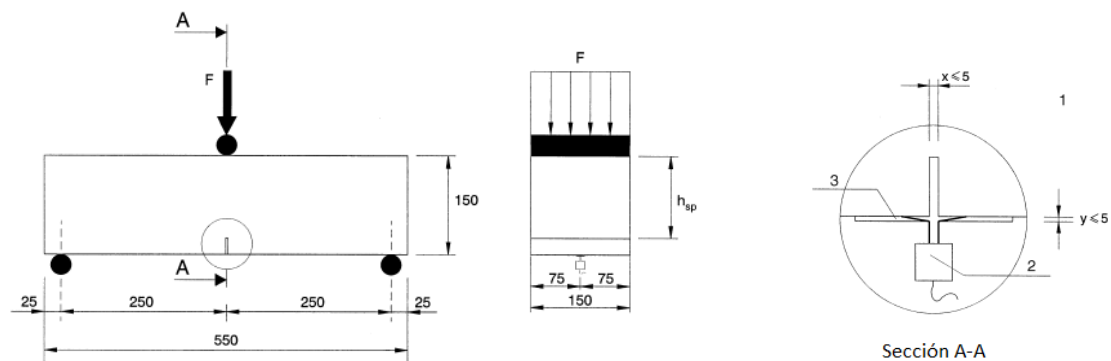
Arreglo típico para determinar la abertura de fisura w. Dimensiones en mm. 1) Detalle de la entalla 2) Transductor 3) Borde de cuchilla [10]
